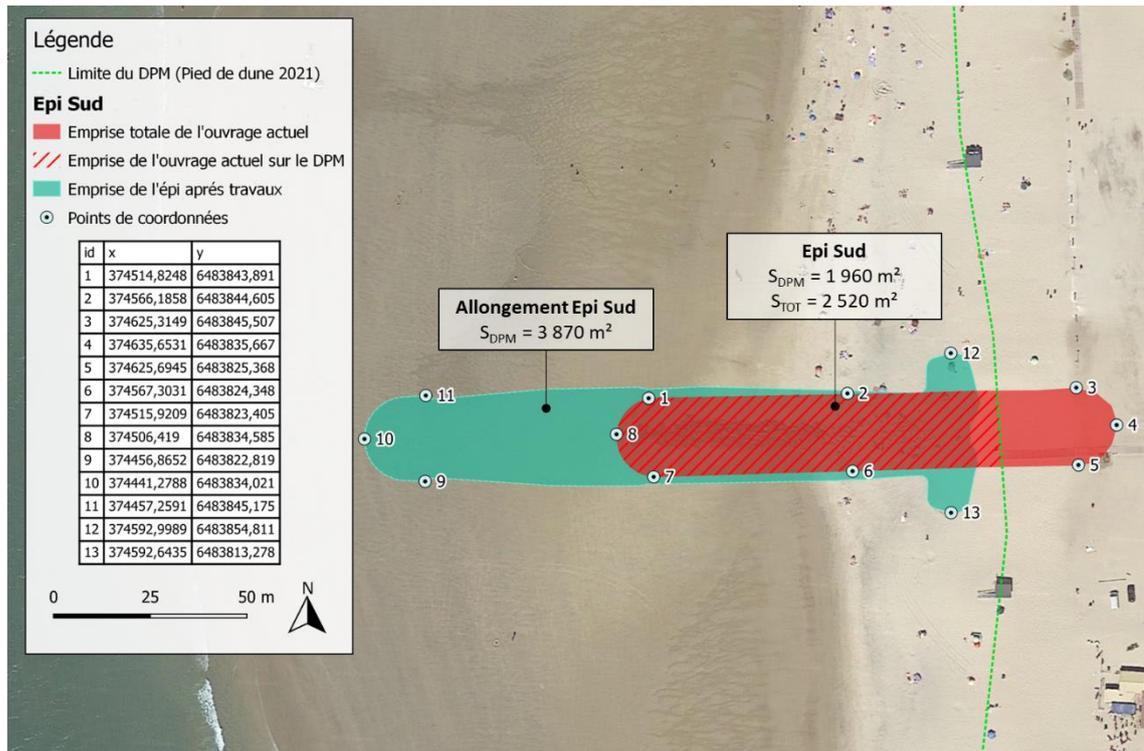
Emprise de l'épi Sud et des travaux d'allongement prévu sur le littoral de Montalivet (Fond de plan : Google Satellite, 2021) - S_{DPM} =Surface de l'ouvrage sur le DPM (en m^2).
